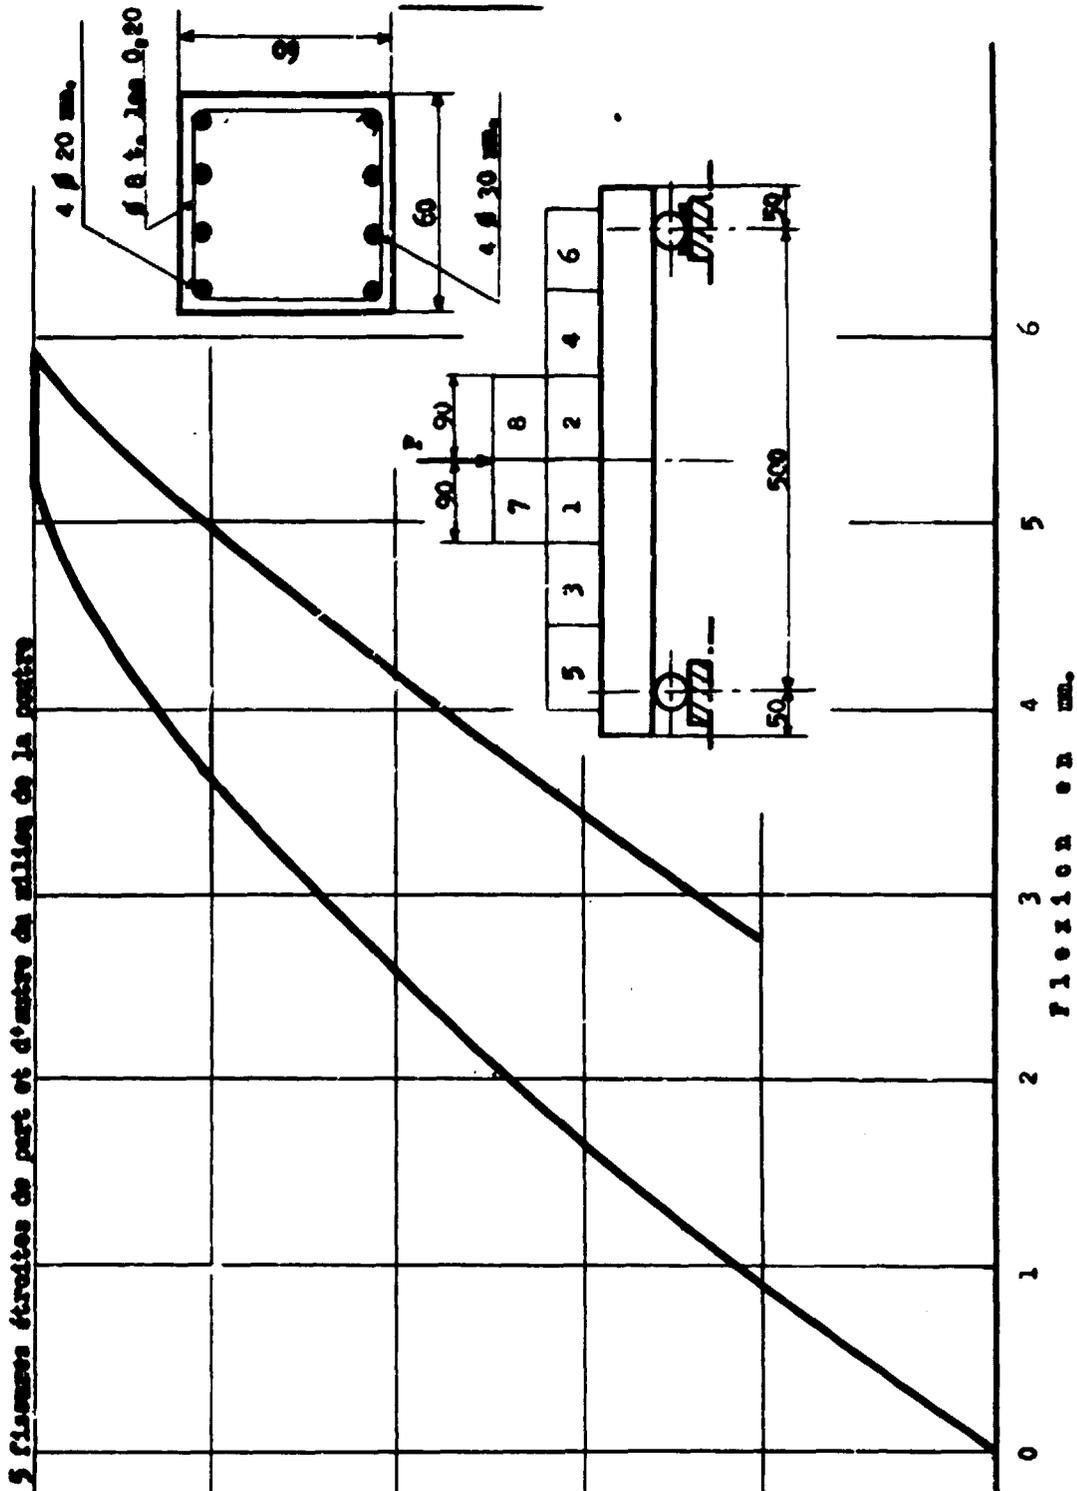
BETON DE BARYTINE - Essai de flexion sur poutre en béton armé.
